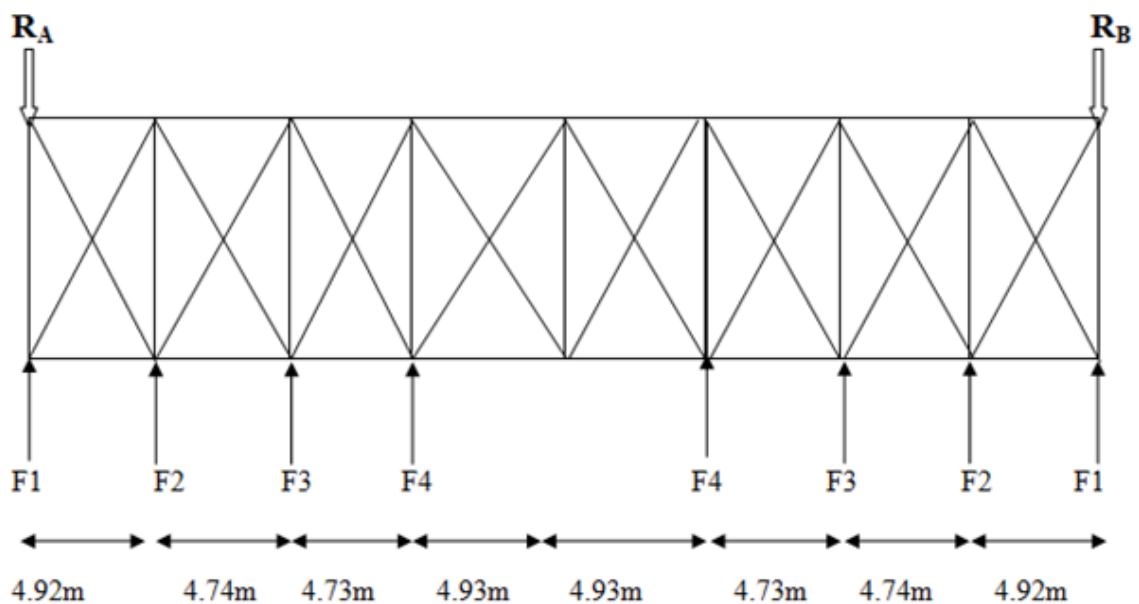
Schéma statique de la poutre au vent en pignon.
